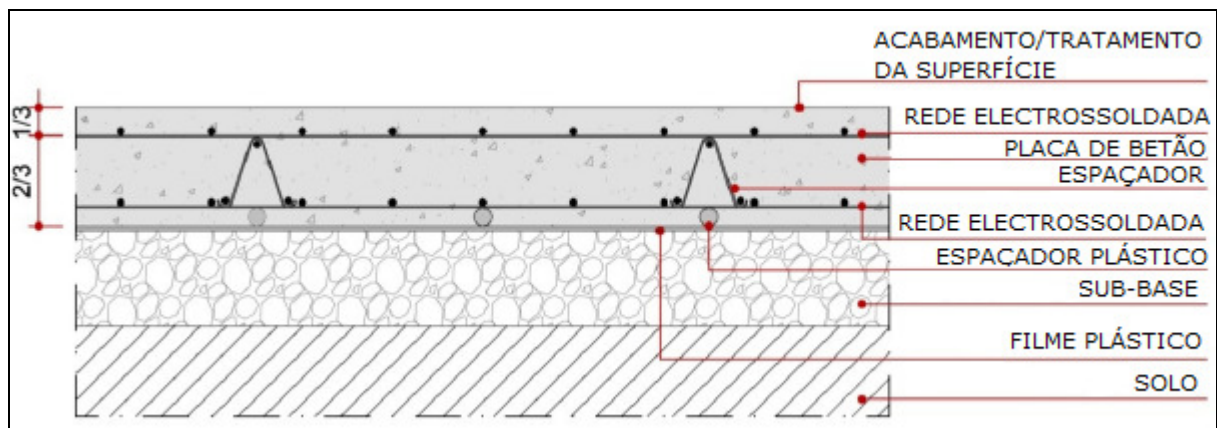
Corte: Pavimento industrial de betão com reforço estrutural (Cristelli, 2010).
